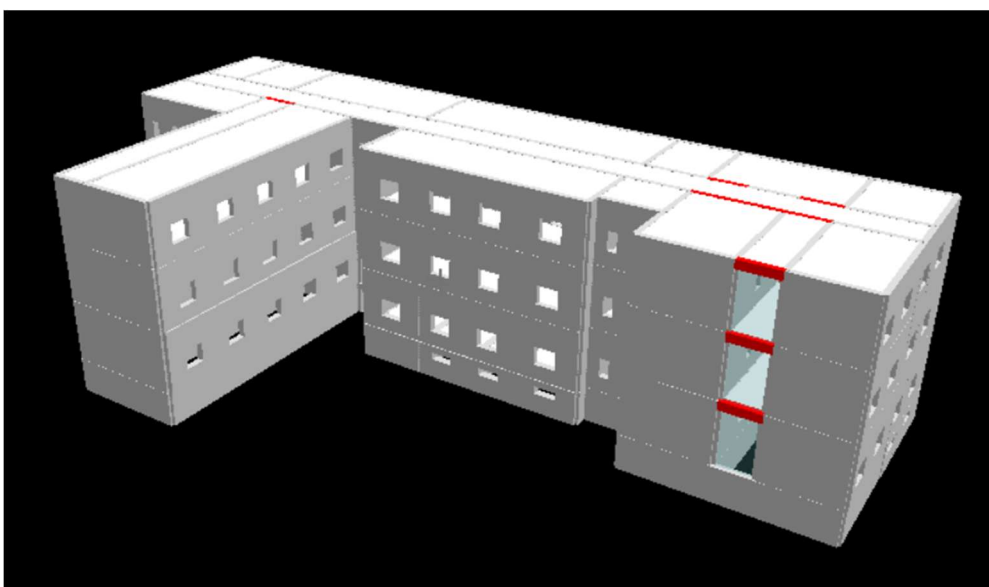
Modello strutturale edificio B5, fronte Ovest.
